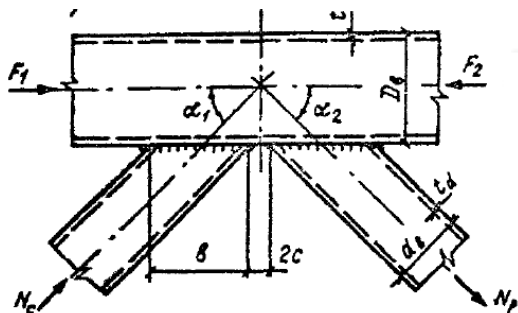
а. Расчетная схема промежуточного узла фермы из ГСП
